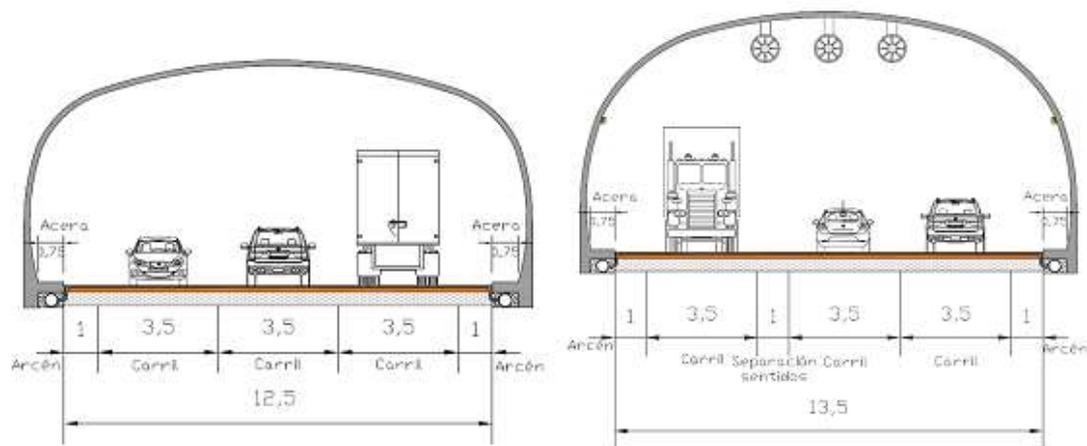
SECCIÓN TIPO 2+1 EN TÚNEL CORTO Y LARGO
